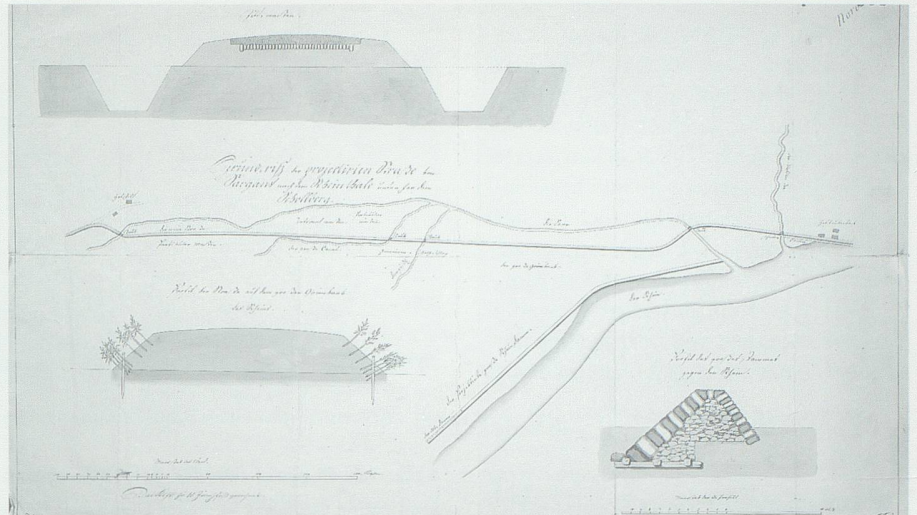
«Plan für die Schollbergstrasse»; undatiert, 1802.
